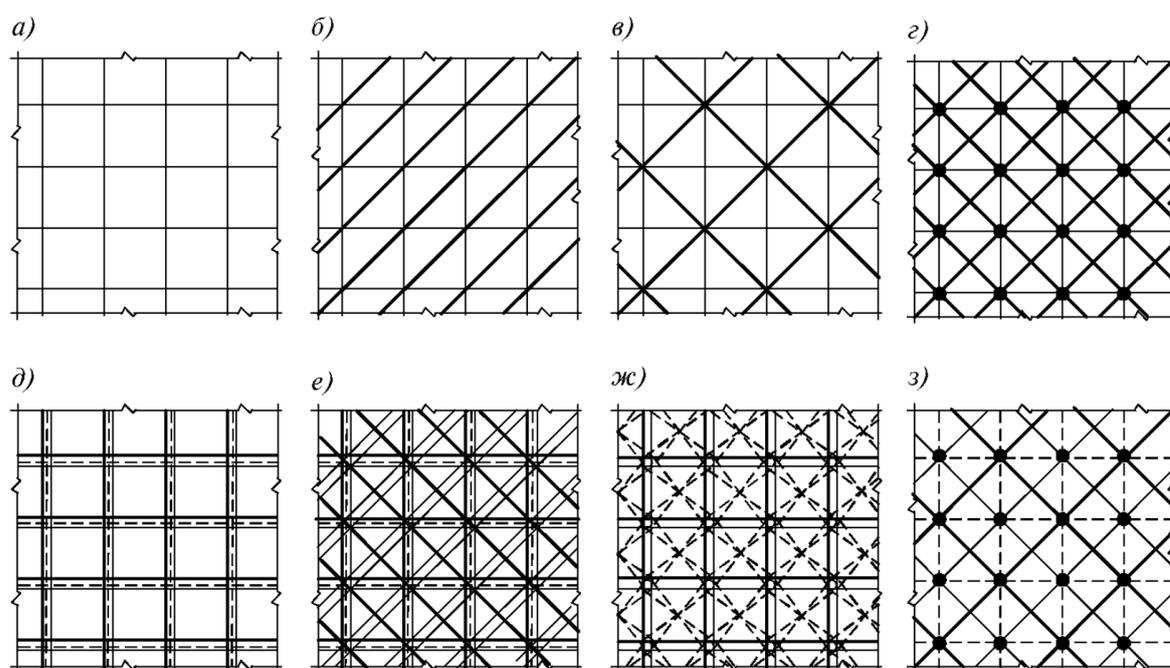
Структуры пространственных покрытий на основе четырехугольной ячейки
